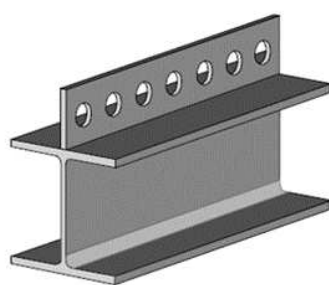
Viga mista aço-concreto com conector *Crestbond
